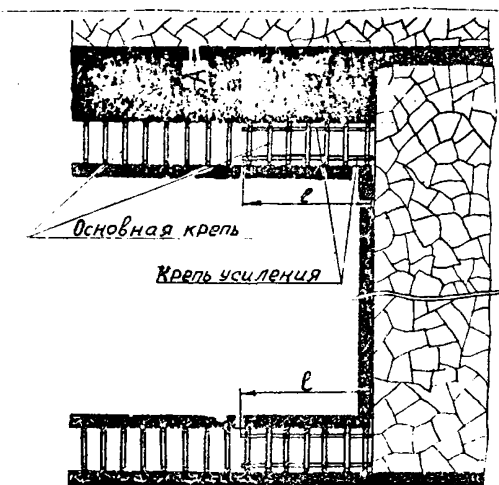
Схема расположения и крепления выработок при охране их целиками угля.
